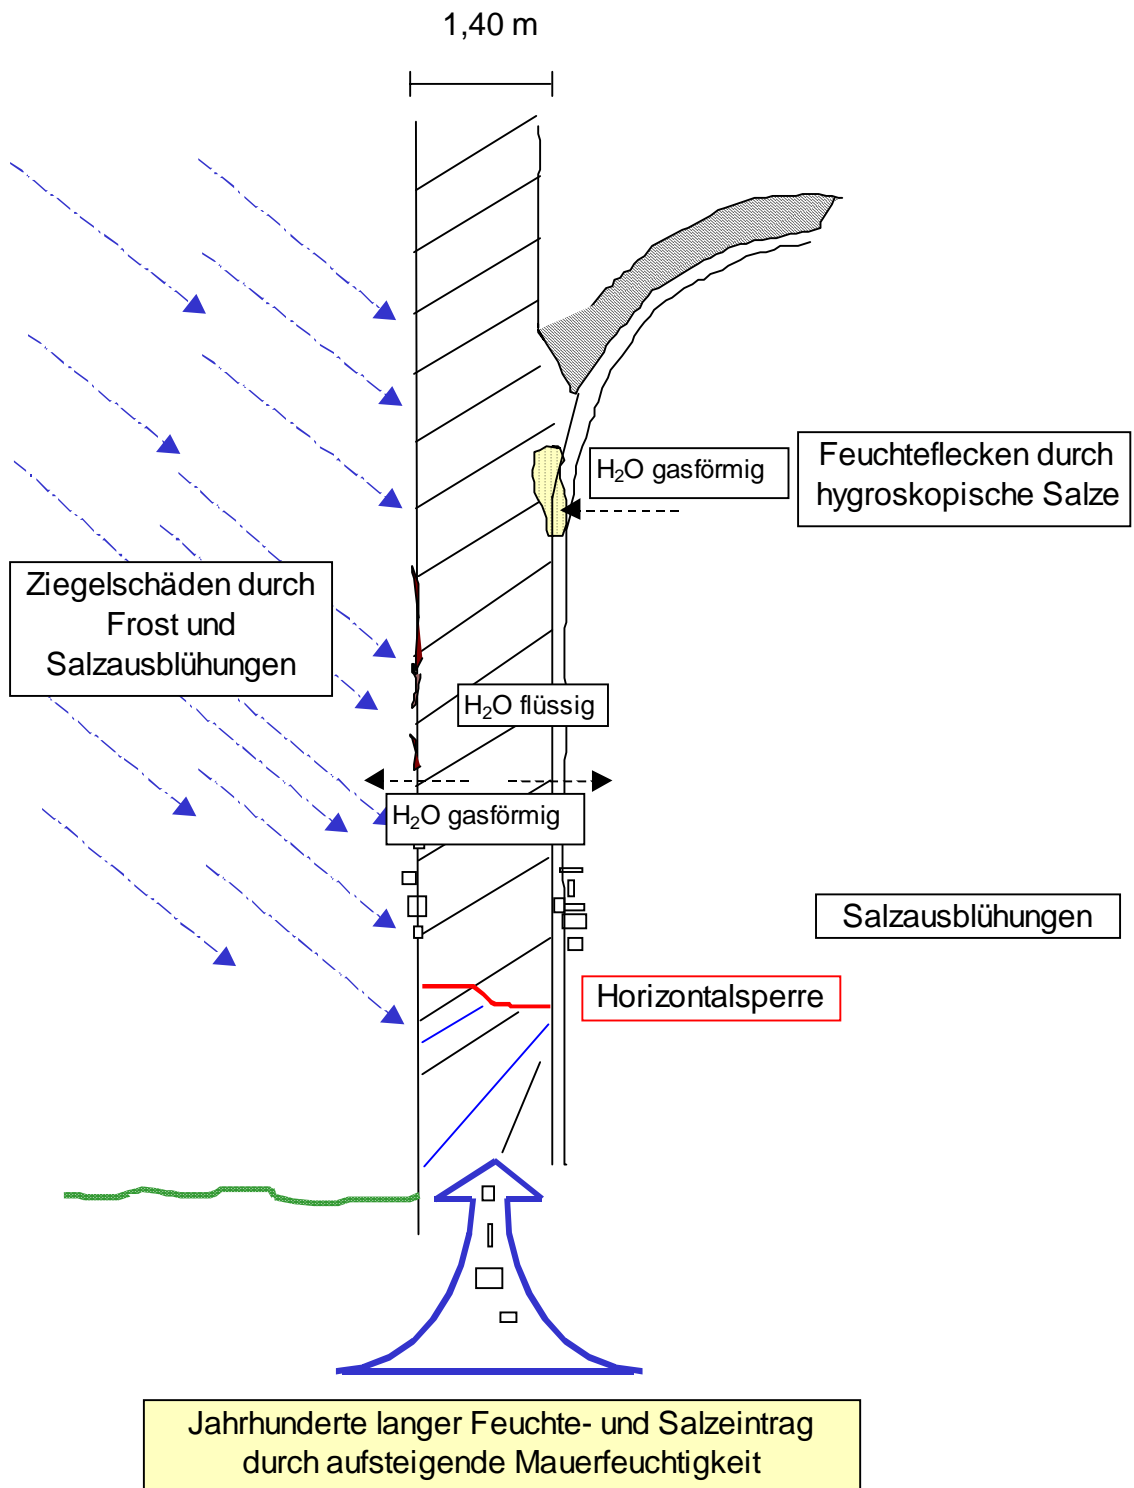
Schadensschema des Mauerwerks der Kirche in Eilsum/Ostfriesland
